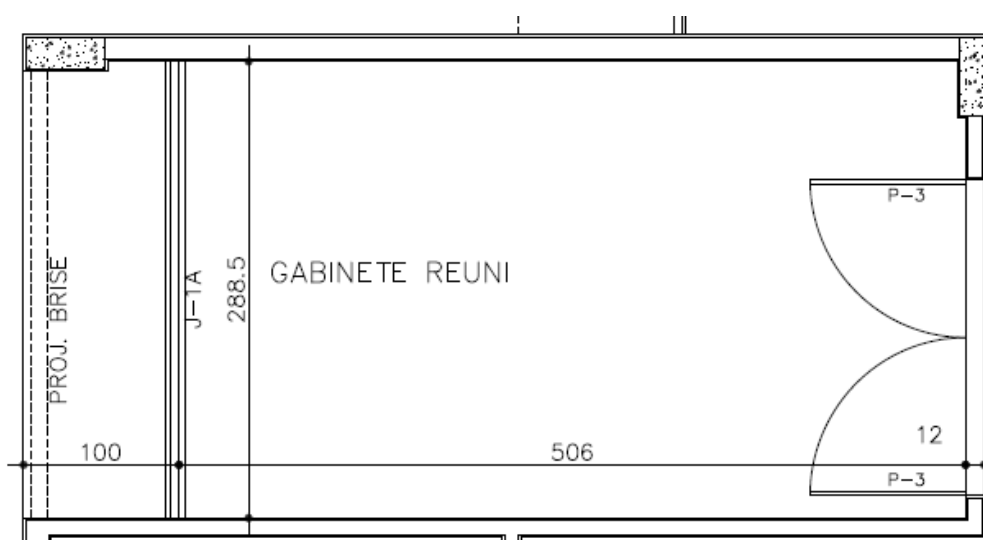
Janela voltada para oeste vista em planta, na primeira alteração.
